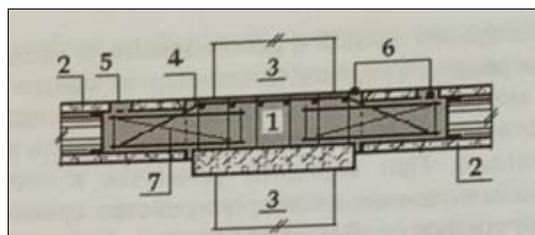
Сечение 1-1 на рис. 2 для варианта сборно-монолитного плитного ригеля, выступающего за нижнюю плоскость перекрытия (с открытыми опорными консолями)
